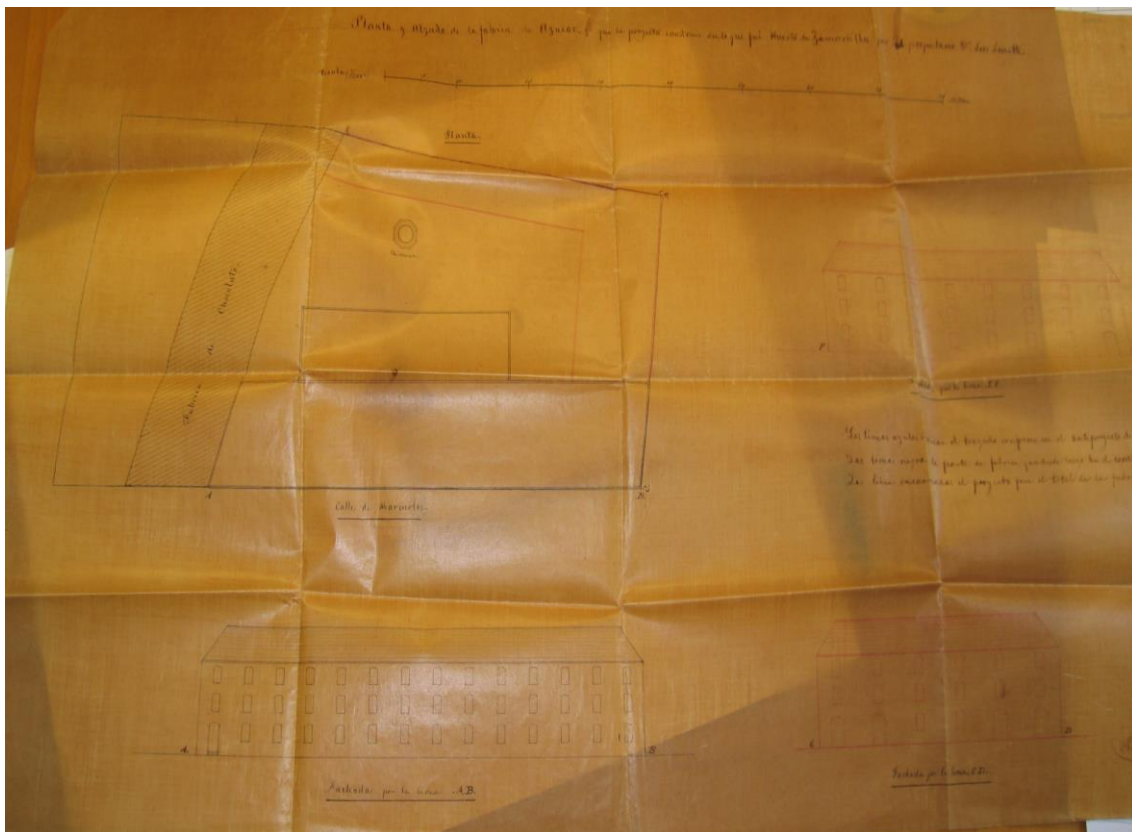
Plano de la planta y alzado de la azucarera La Concepción. Fuente: AHMMA
